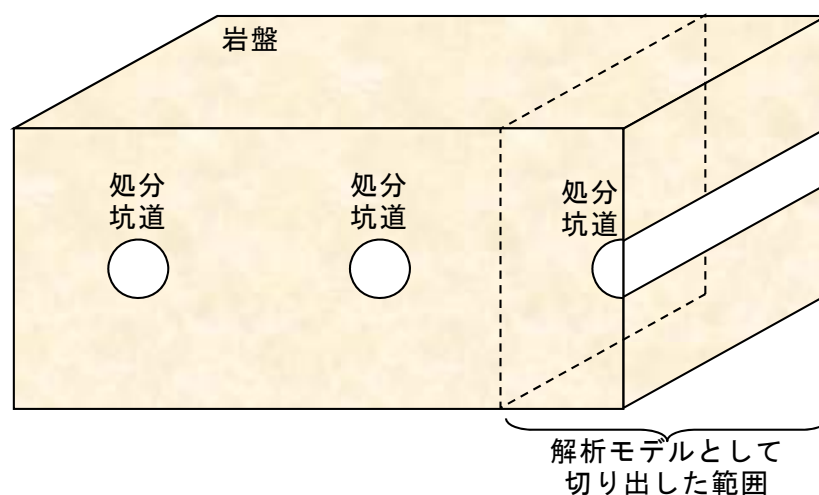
処分坑道の配置とモデル化した範囲の模式図
